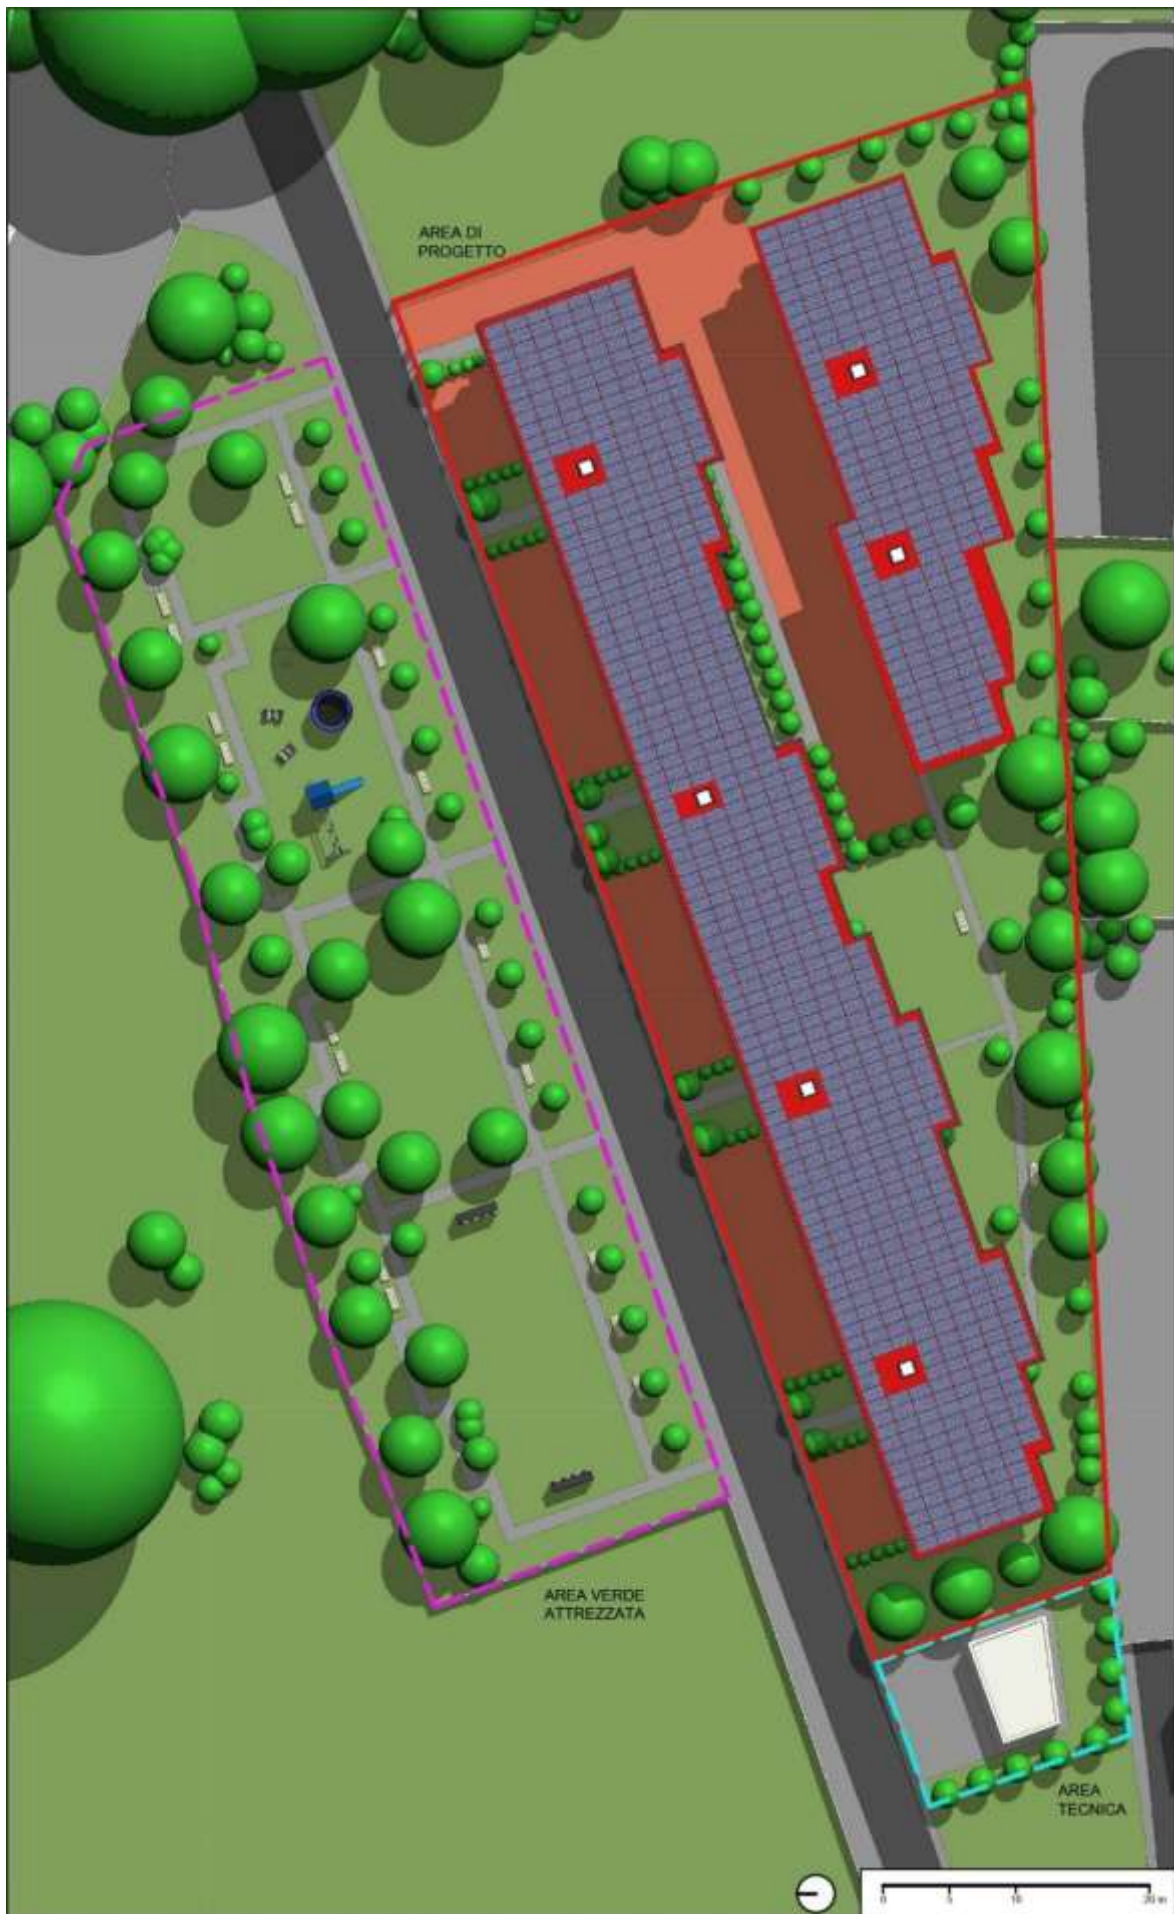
Planivolumetria dello stato di progetto. [Fonte: elaborazione dell'autore]
